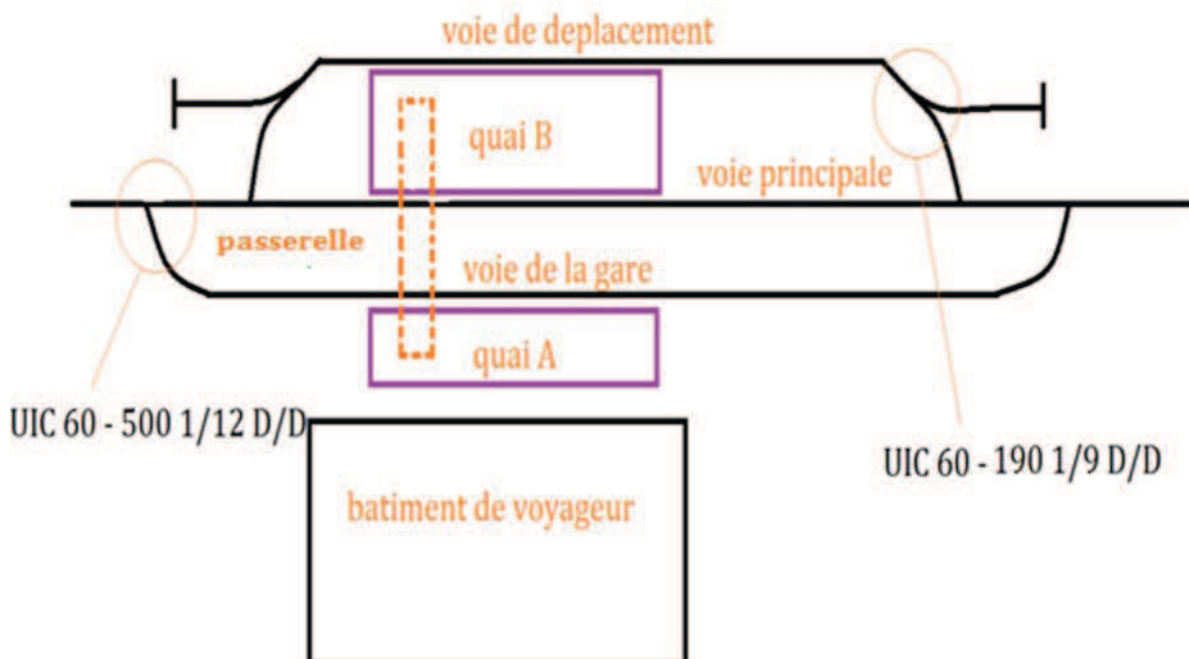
Plan de masse de la gare Colonel Boughara
